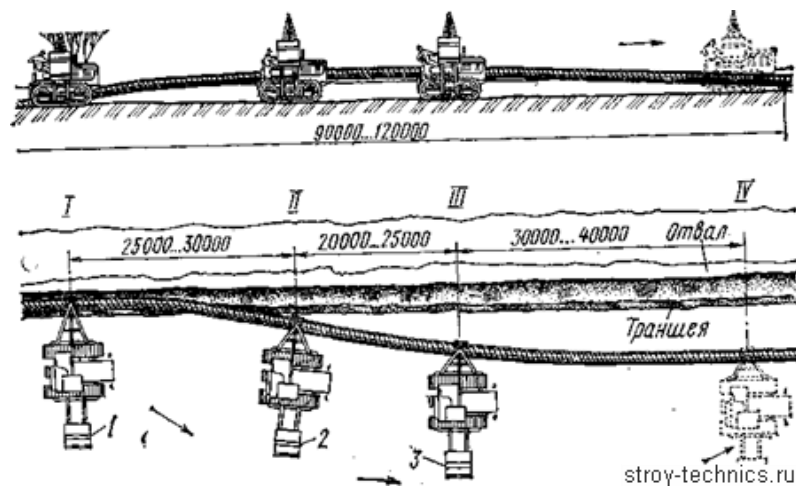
Схема укладки трубопровода в траншею.
